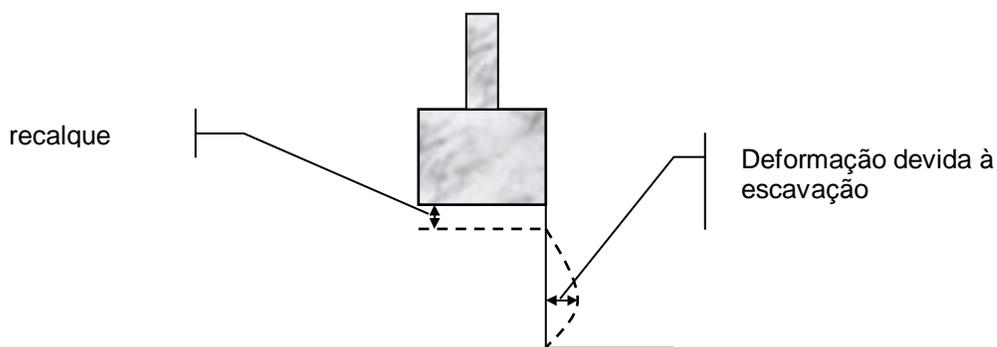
Recalque de fundação proveniente da deformação do solo devido à escavação (DAL MOLIN, 1988).
